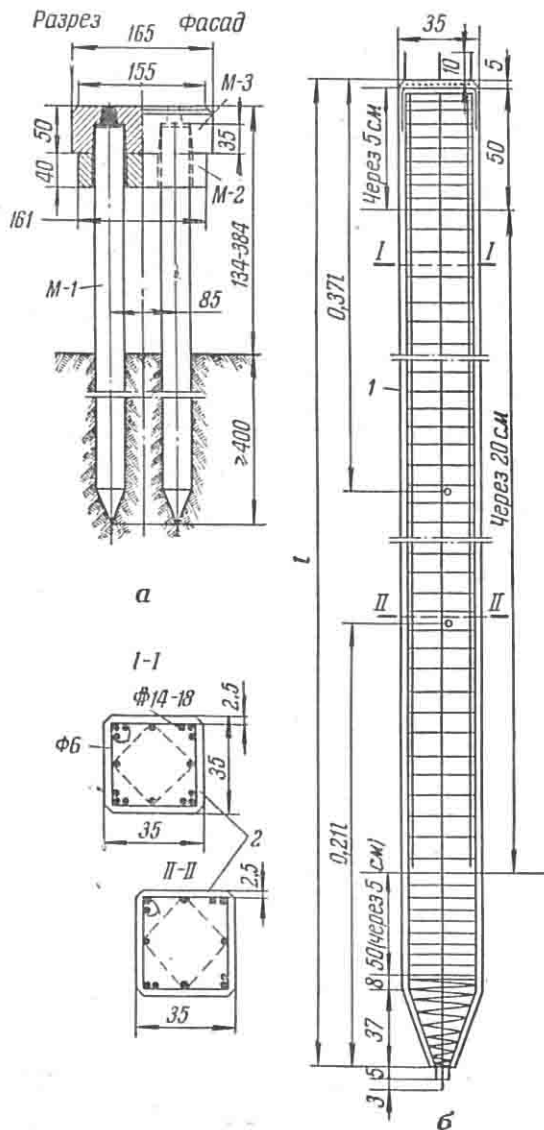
Сборная железобетонная свайная промежуточная опора:
